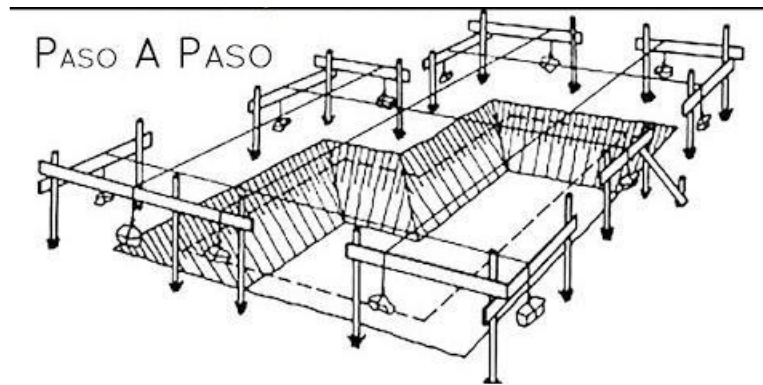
Excavación de zanja luego del replanteo de la cimentación. (Castro, 2018)
